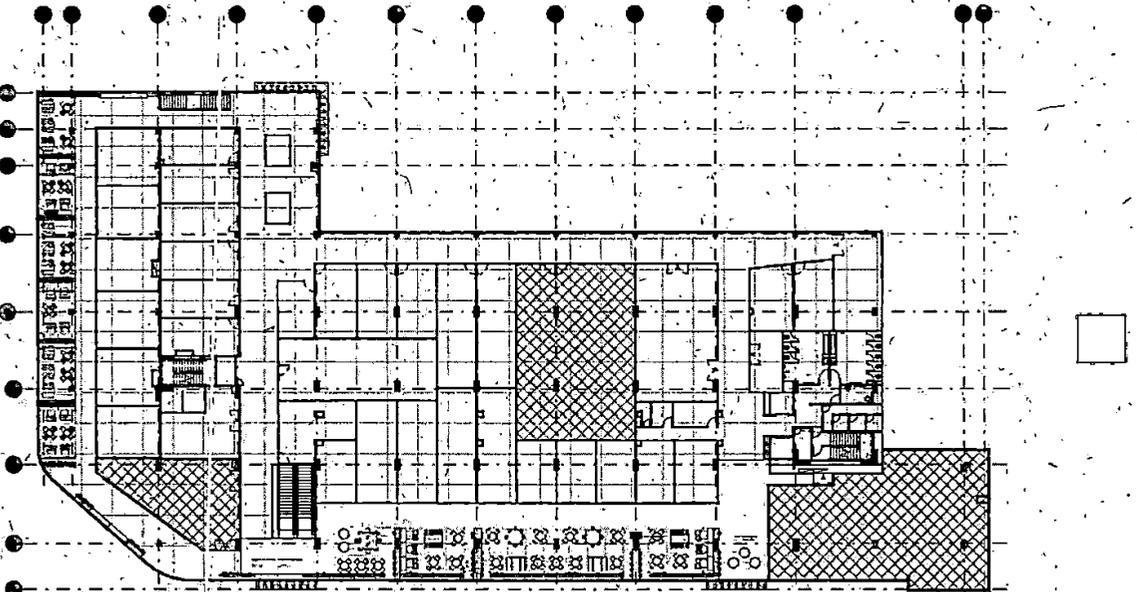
Distribución de particiones en zona de locales en arquitectura Piso 1, (Modificación).
